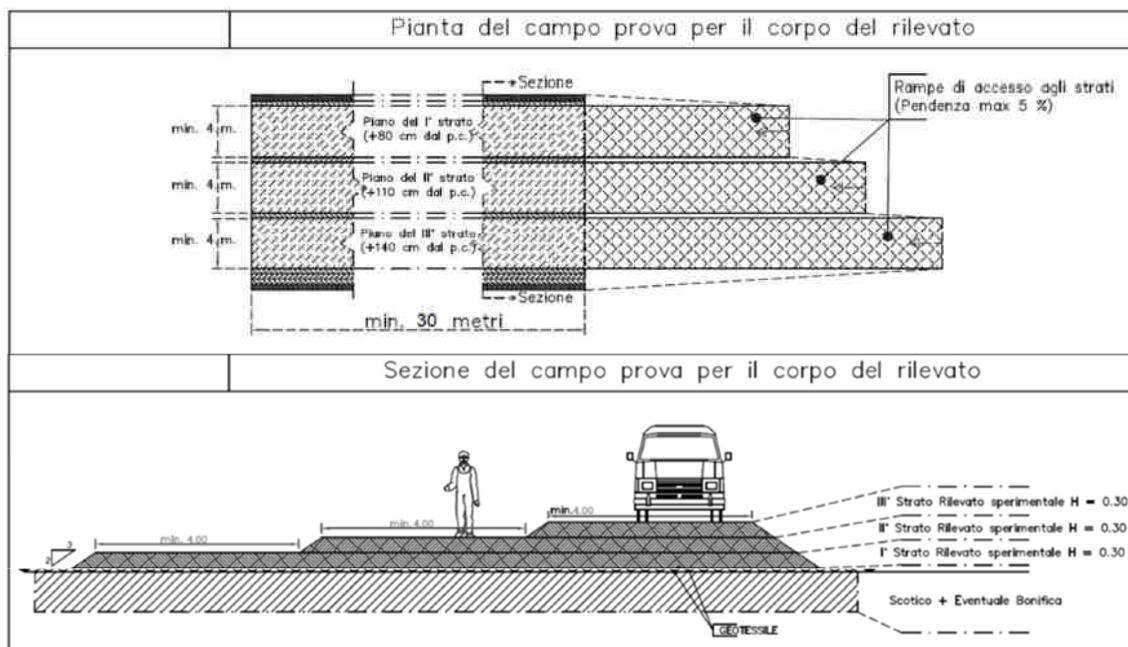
Schema in pianta ed in sezione del campo prova per il corpo del rilevato
